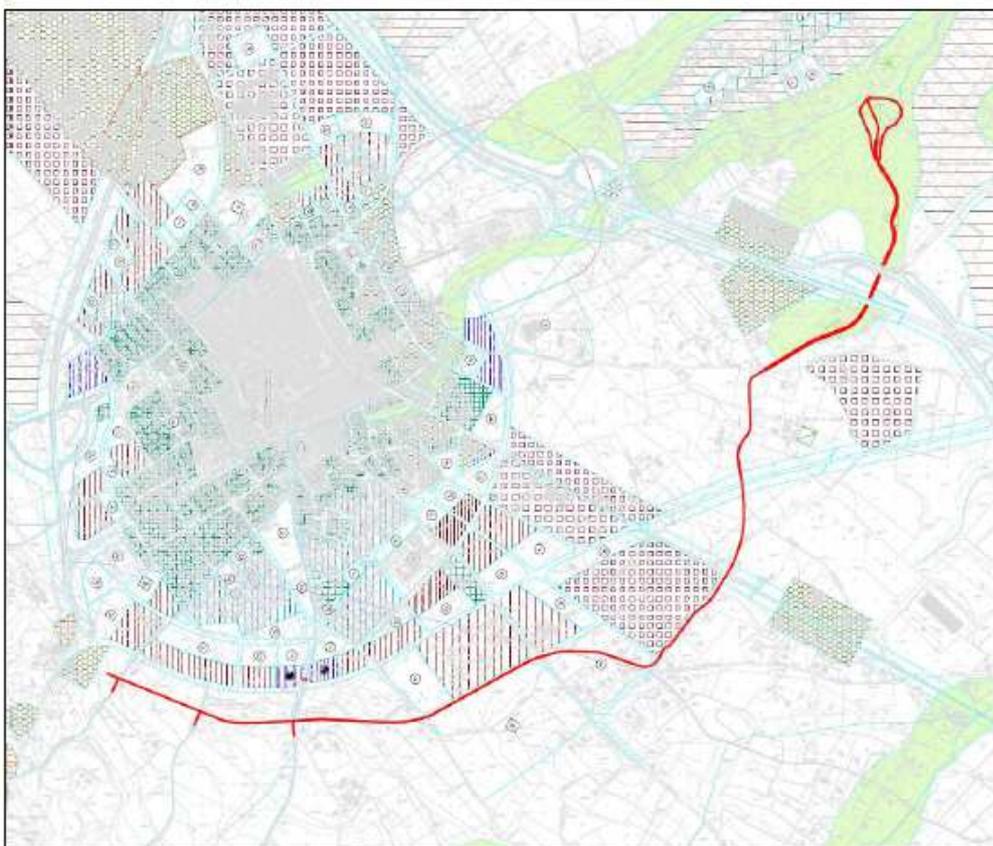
Planimetria della soluzione progettuale. Tracciato di progetto del canale scolmatore
